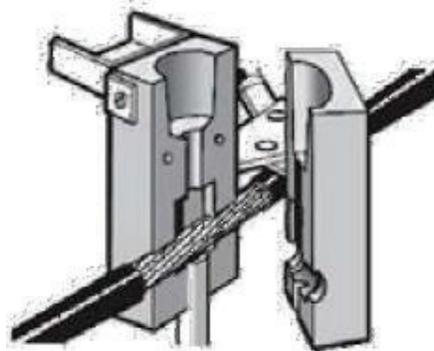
Colocación de la varilla Copperweld y el alambre de cobre en el molde.
